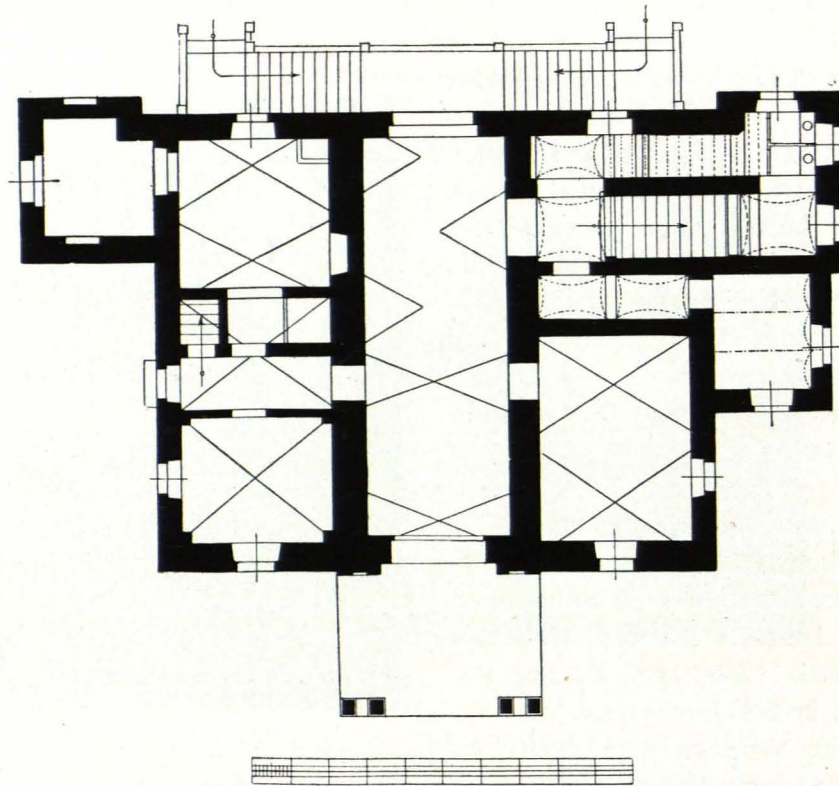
Schloß Emslieb. Grundriß des Erdgeschosses 1 : 200 (S. 411)
